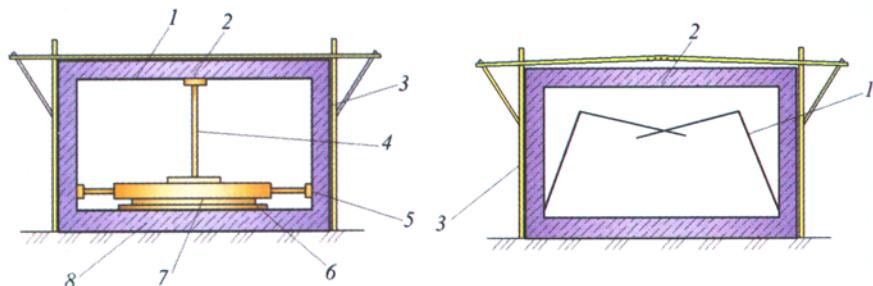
Катучая опалубка для бетонирования тоннелей:
